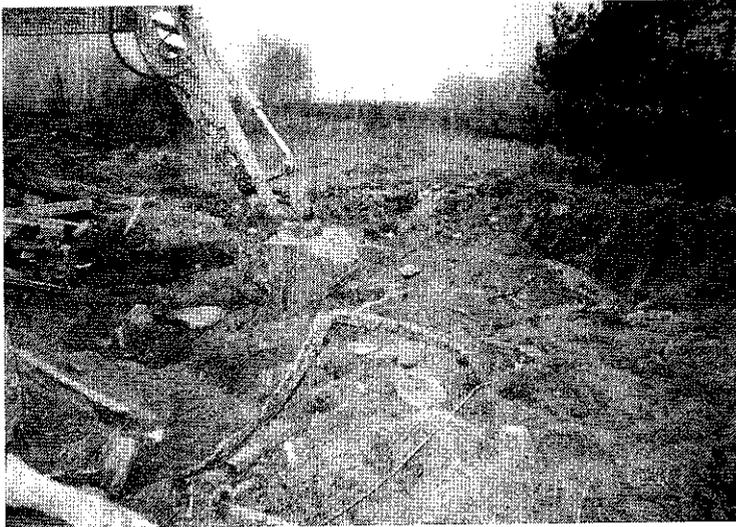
Rückbau der Fundamente Tankstellengebäude am 04.12.01
